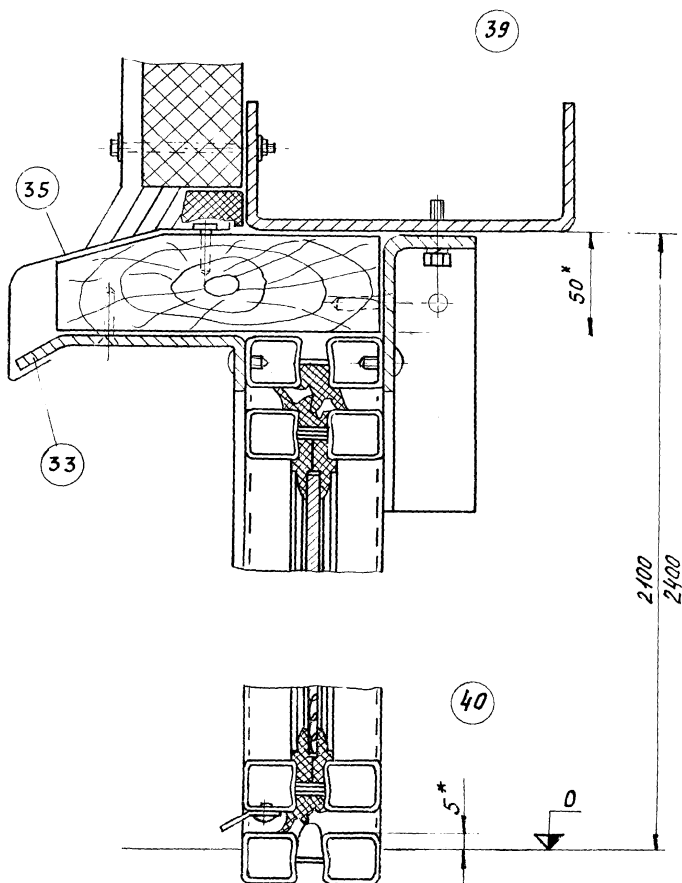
Установка дверного блока типа ДТО и ДТГ
